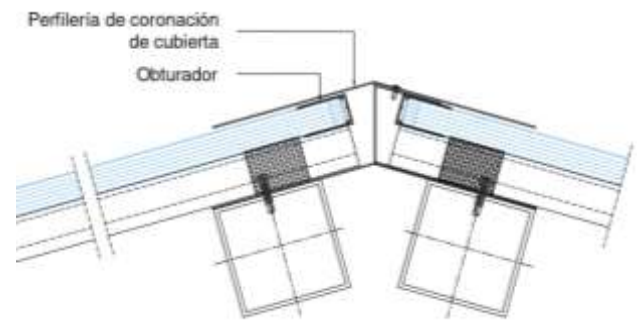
Instalación del sistema como cerramiento de cubierta. Detalle vierteaguas (parte superior).
